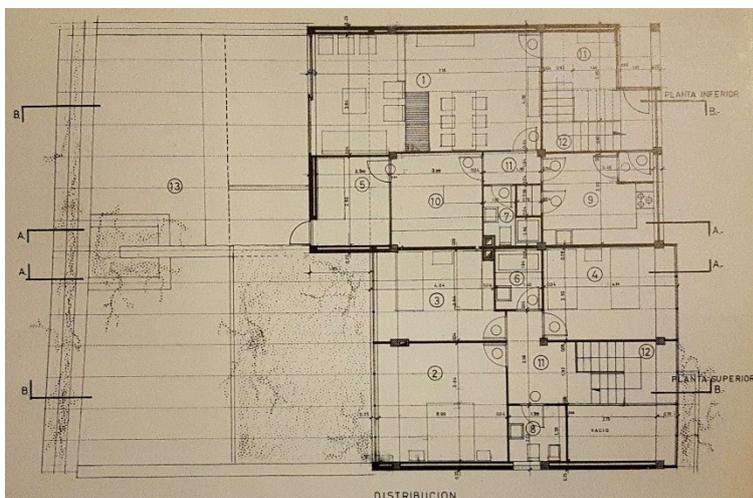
Planta Distribución V-1-4. 1964. Fuente: Archivo Municipal da Coruña.
